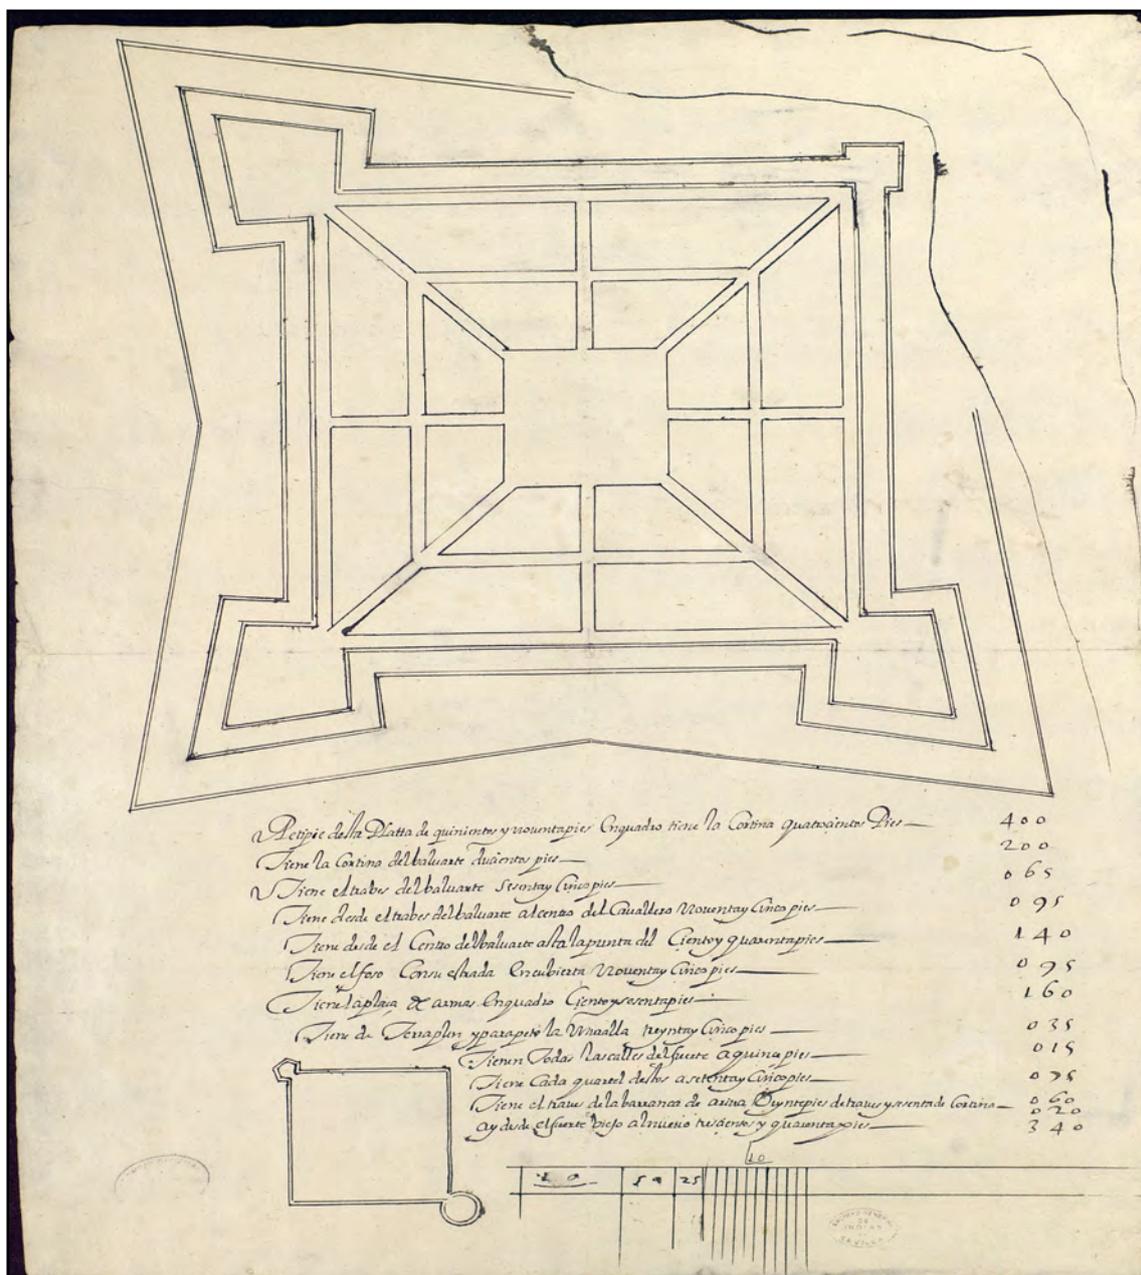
Planta de la fuerza nueva que se hace en Ternate, 1606⁸³⁴.
